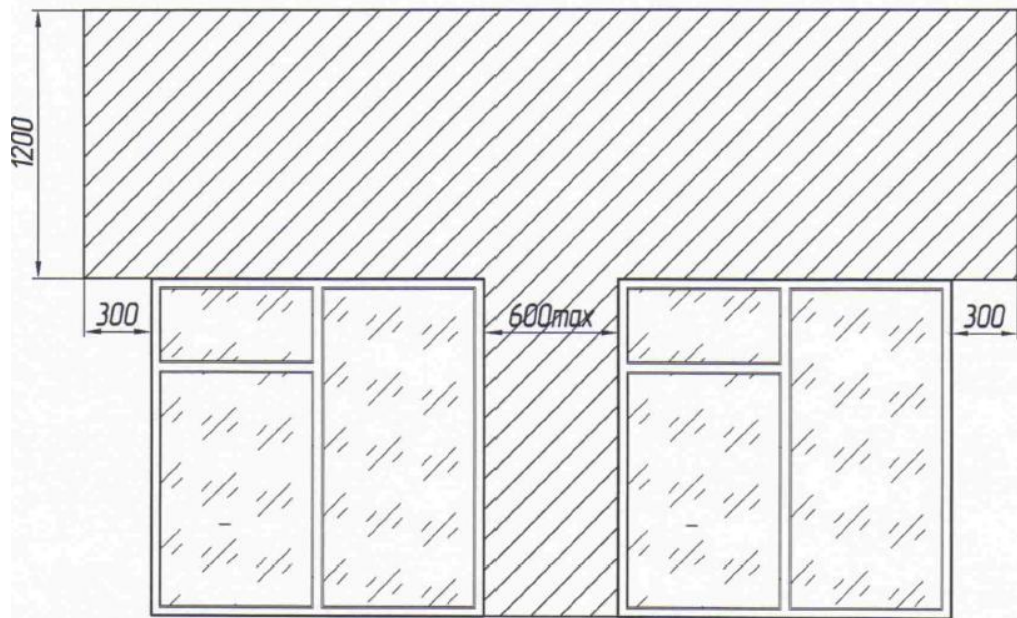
участки фасада с особыми требованиями к монтажу системы по пожарной безопасности.
